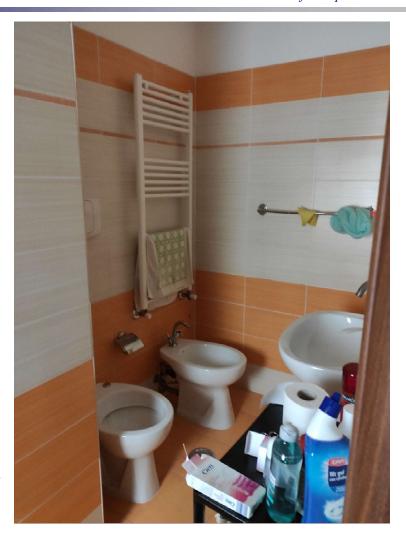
Secondo bagno, ricavato dalla divisione in due dell'unico bagno inizialmente presente come da catastale,
